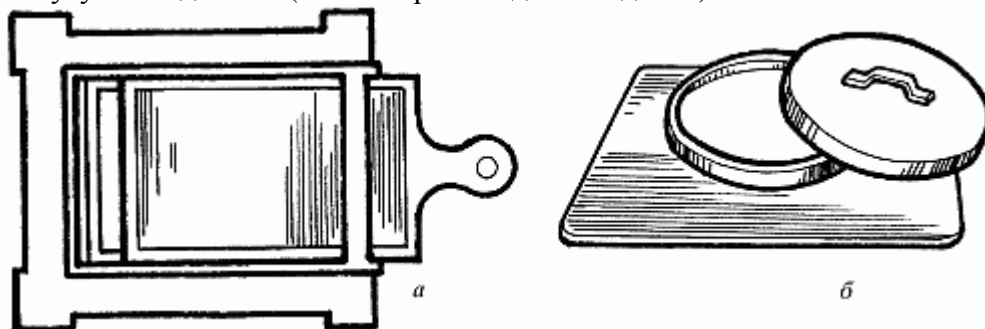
Запорные приспособления: а – вьюшка; б – задвижка
